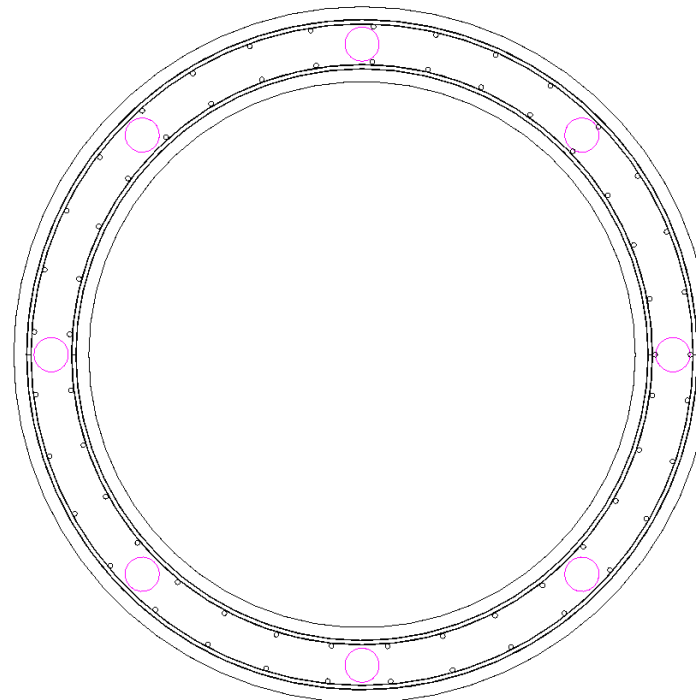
Seccions transversals plantejades al WindCrete 2 MW.
